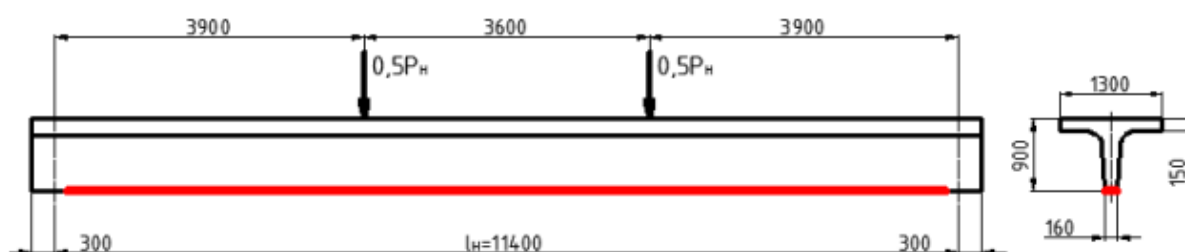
Схема внешнего армирования экспериментальной балки
